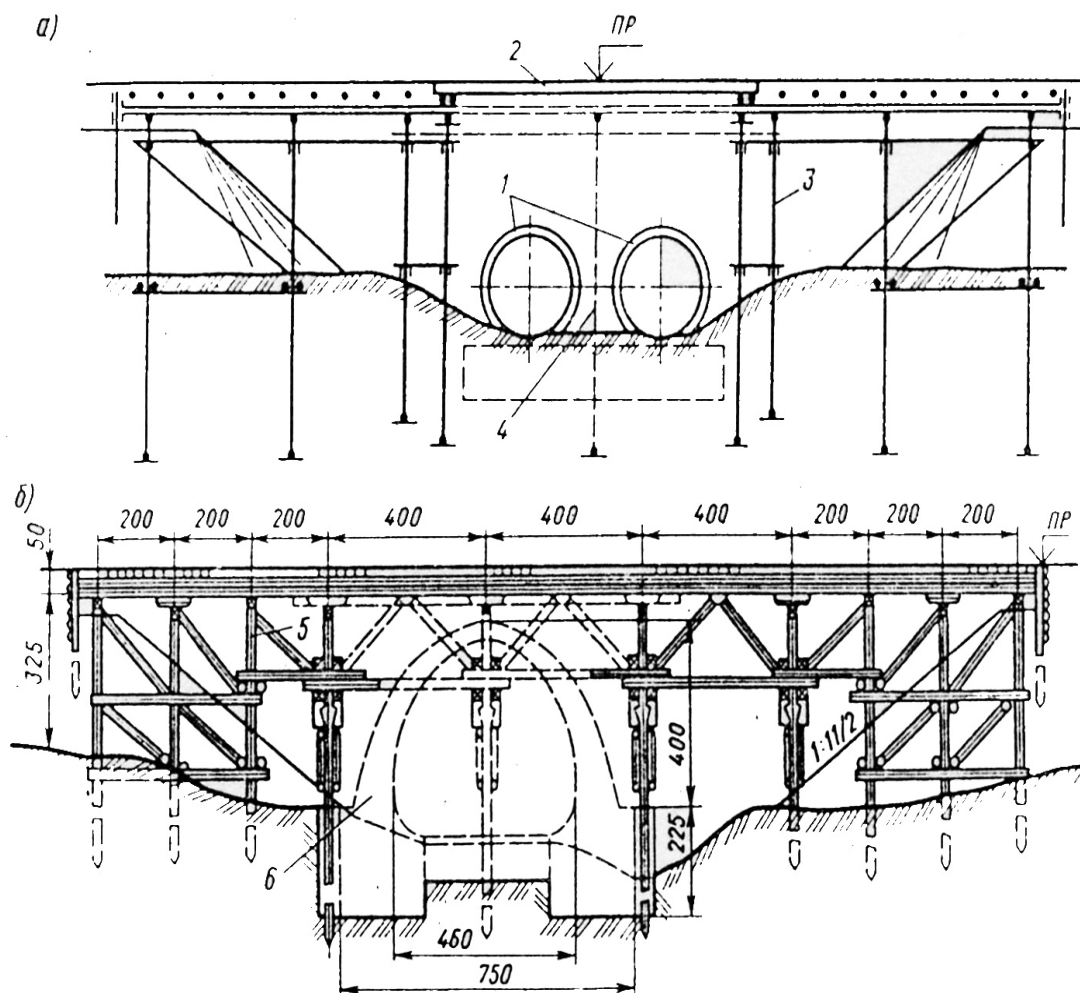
Схема переустройства деревянных мостов на двухочковую железобетонную трубу (а) и на массивную трубу (б):
